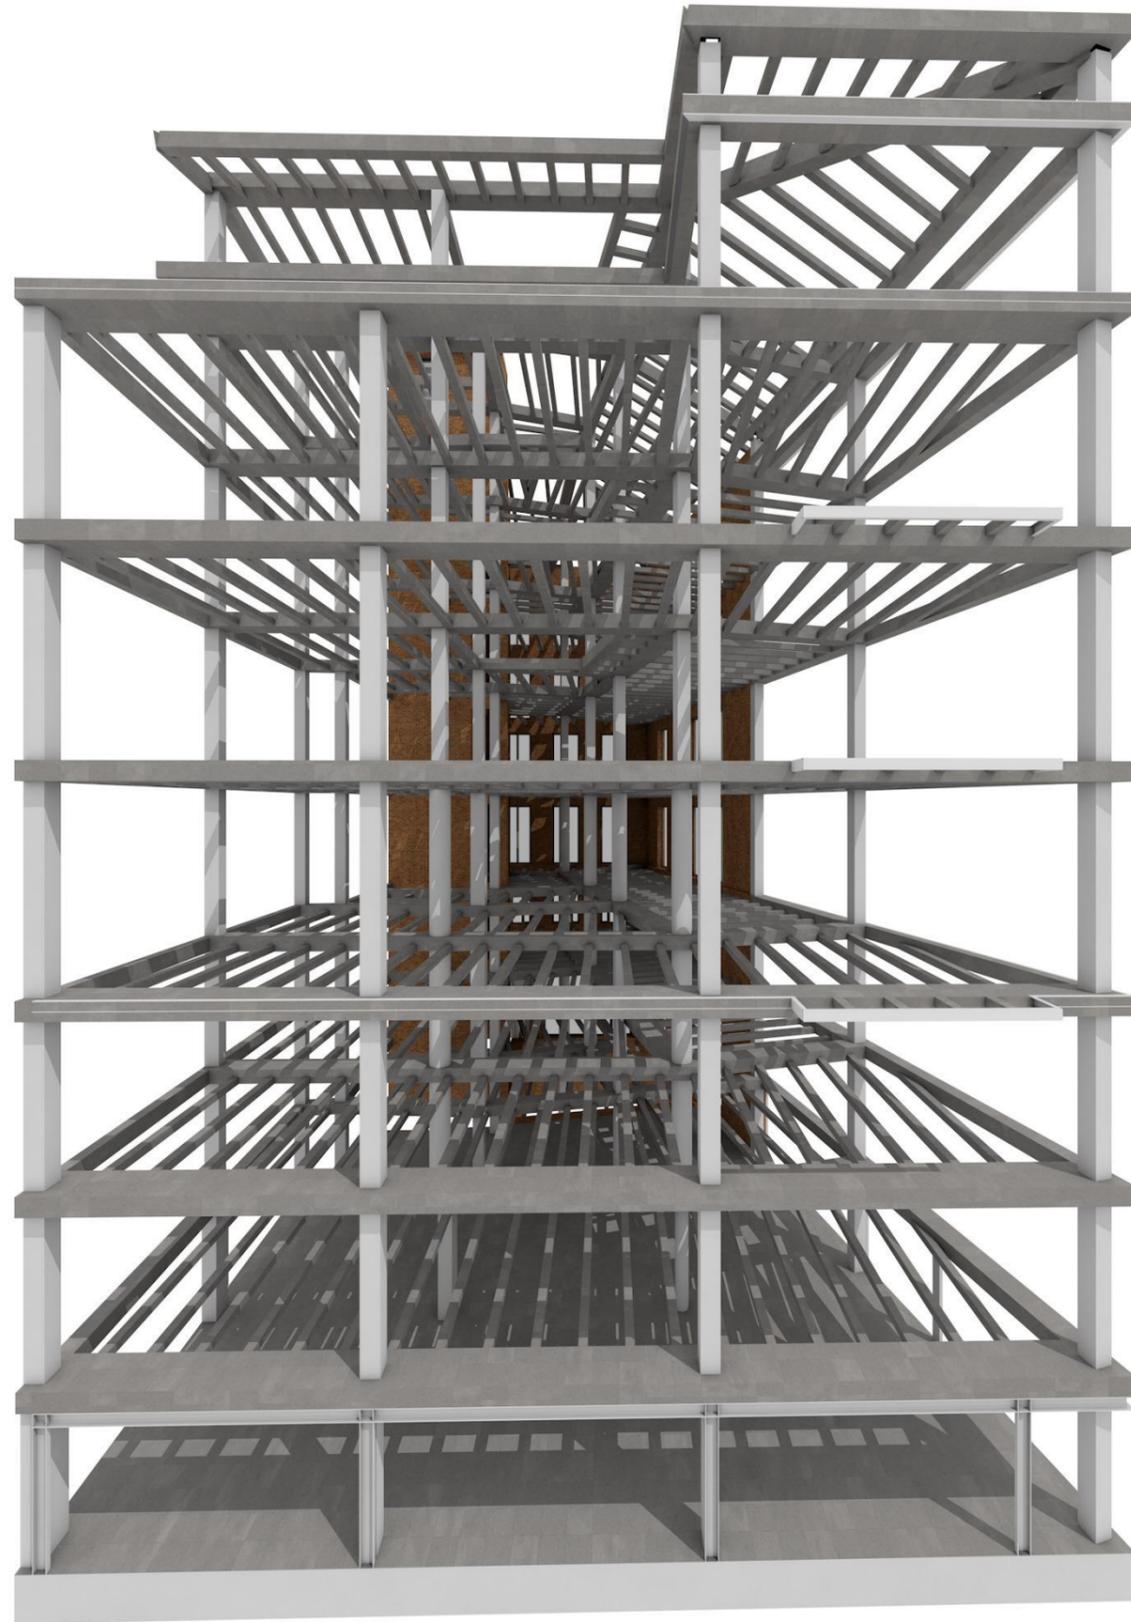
Modelo BIM Archicad. Vista general estructura.
